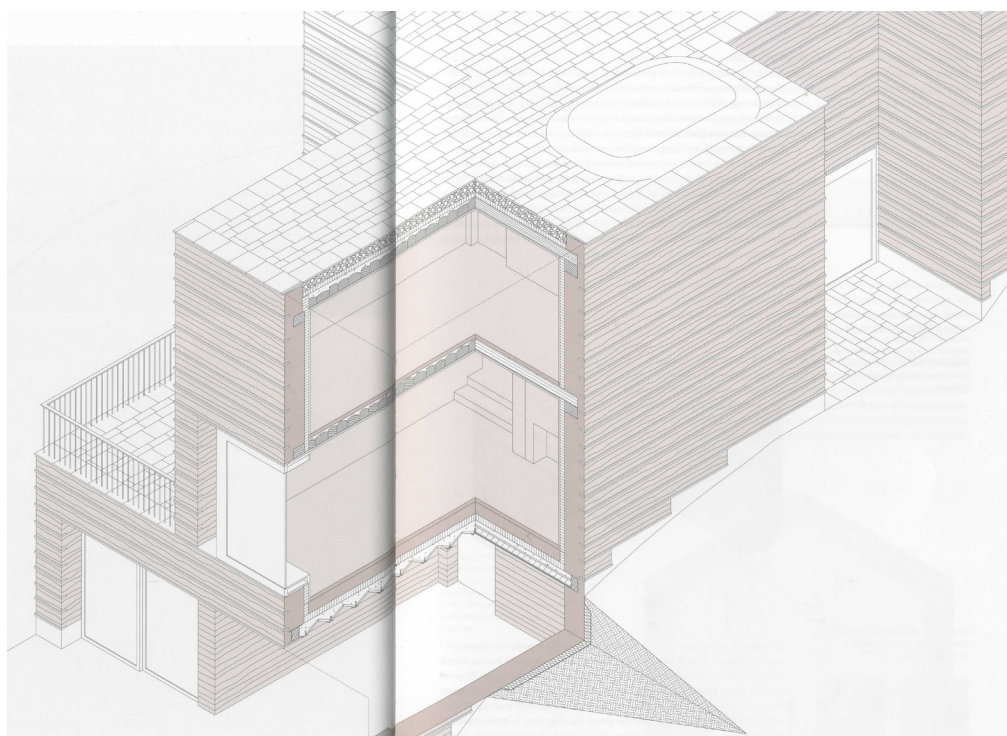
Axonometría seccionada Casa Rauch. El tapial en contacto con el terreno posee un aislamiento exterior de espuma de vidrio y una lámina bituminosa y el tapial queda visto en su parte interior. En plantas superiores las paredes se aíslan en el interior con dos capas de esteras de caña, excepto el hueco de la escalera sin aislar que posee un espesor continuo de 65cm.
